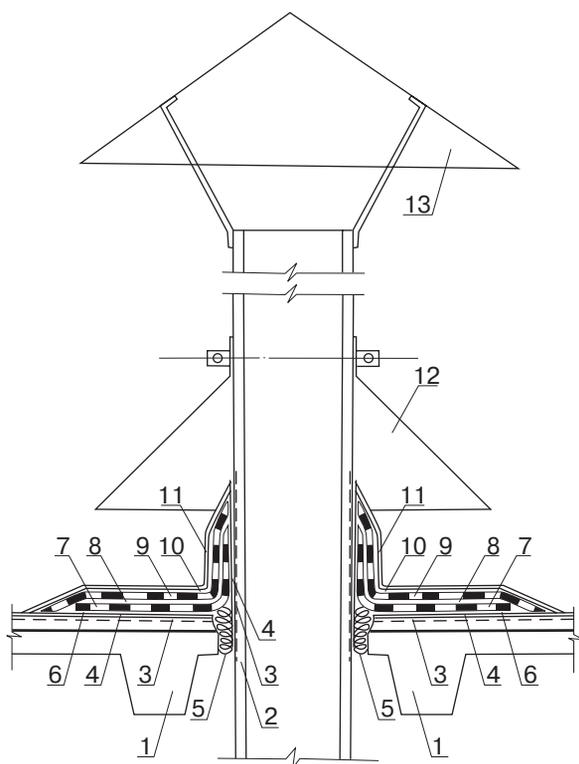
Герметизация сопряжения вентиляционной трубы с кровельными панелями: 1 – железобетонная панель перекрытия; 2 – труба; 3 – зона очистки (пунктир); 4 – грунтовка; 5 – праймер, пропитанная грунтовкой; 6 – приклеивающий слой мастики; 7, 9 – армирующая ткань; 8 – второй приклеивающий слой; 10 – защитный слой мастики; 11 – посыпка слюдой, хлорсульфополиэтиленовый (ХСПЭ) лак, наполненный алюминиевой пудрой (15%), 12 – фартук; 13 – флюгарка
